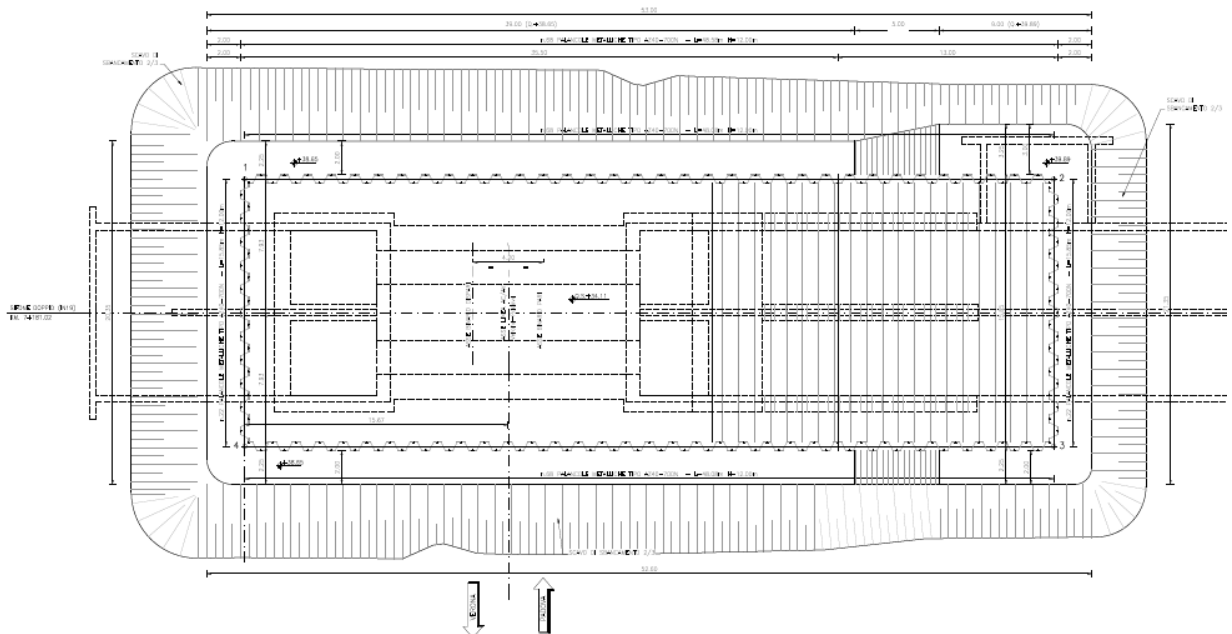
Planimetria opere provvisorie scavi in corrispondenza del sifone
